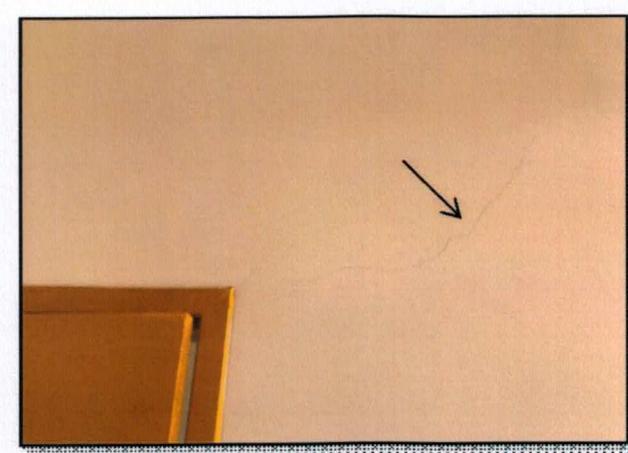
Foto da Parede: Fissura inclinada – SAL DE EXAMES
